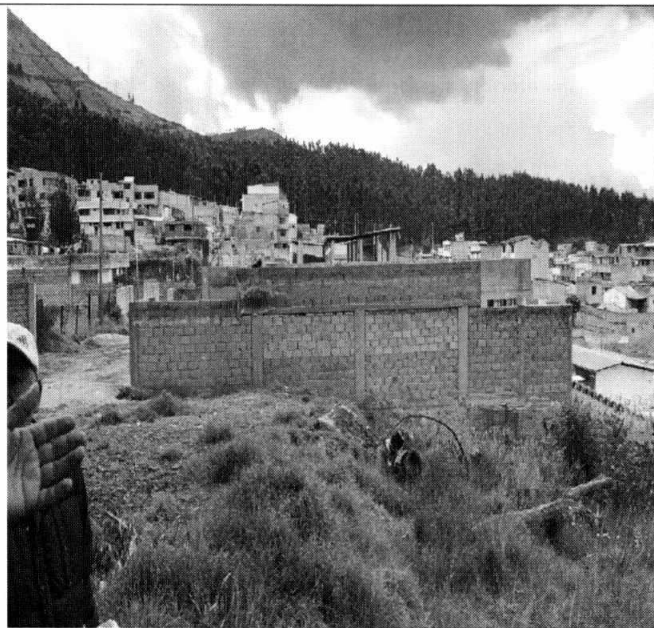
Vista Exterior / Construcción N° 1 / vista Lateral
